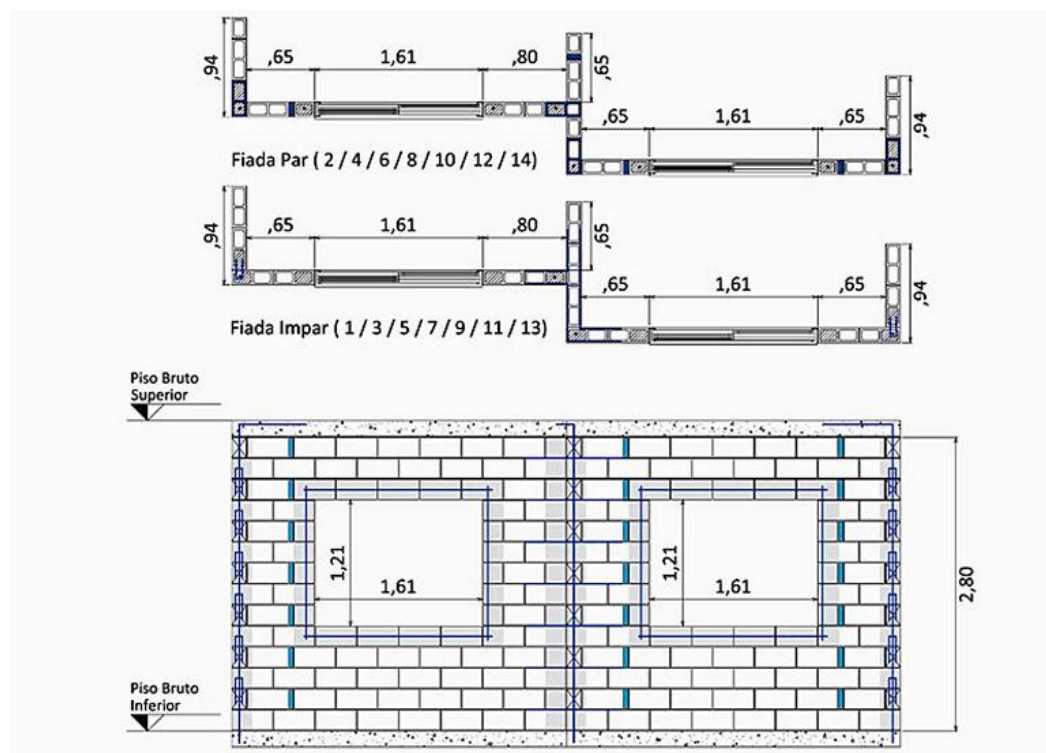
Alvenaria Não Armada (TAUIL, 2010)
